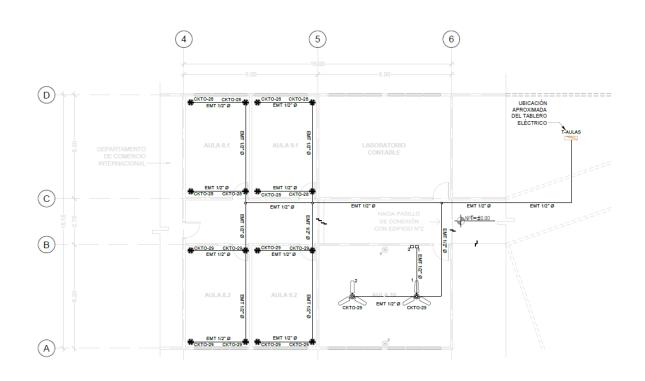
Planta de ventiladores, Primer nivel Edificio N°1
